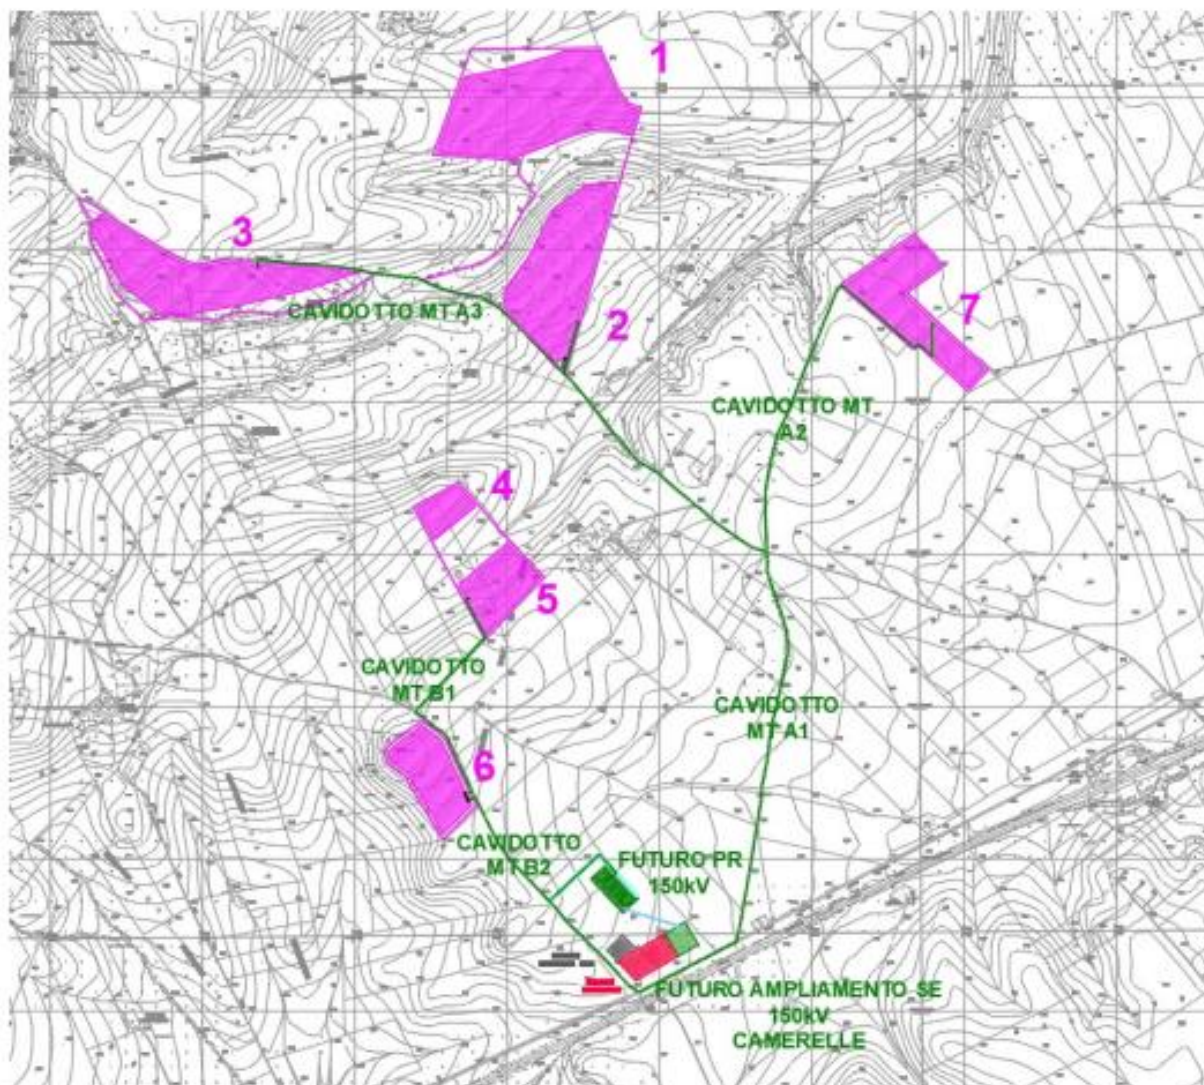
Planimetria CTR con indicazione dei cavidotti MT
